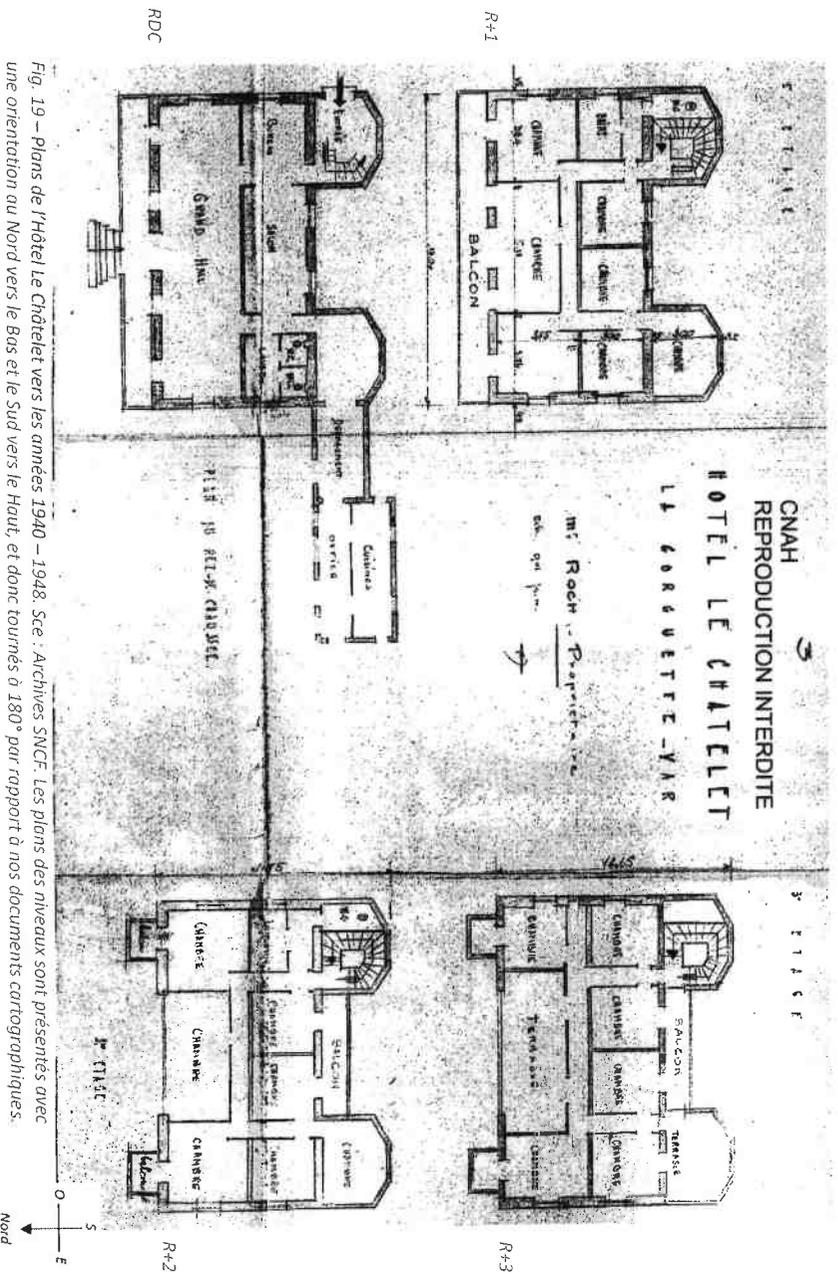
Plans de l'hôtel Le Châtelet vers les années 1940 – 1948. See : Archives SNCF. Les plans des niveaux sont présentés avec une orientation au Nord vers le Bas et le Sud vers le Haut, et donc tournés à 180° par rapport à nos documents cartographiques.
